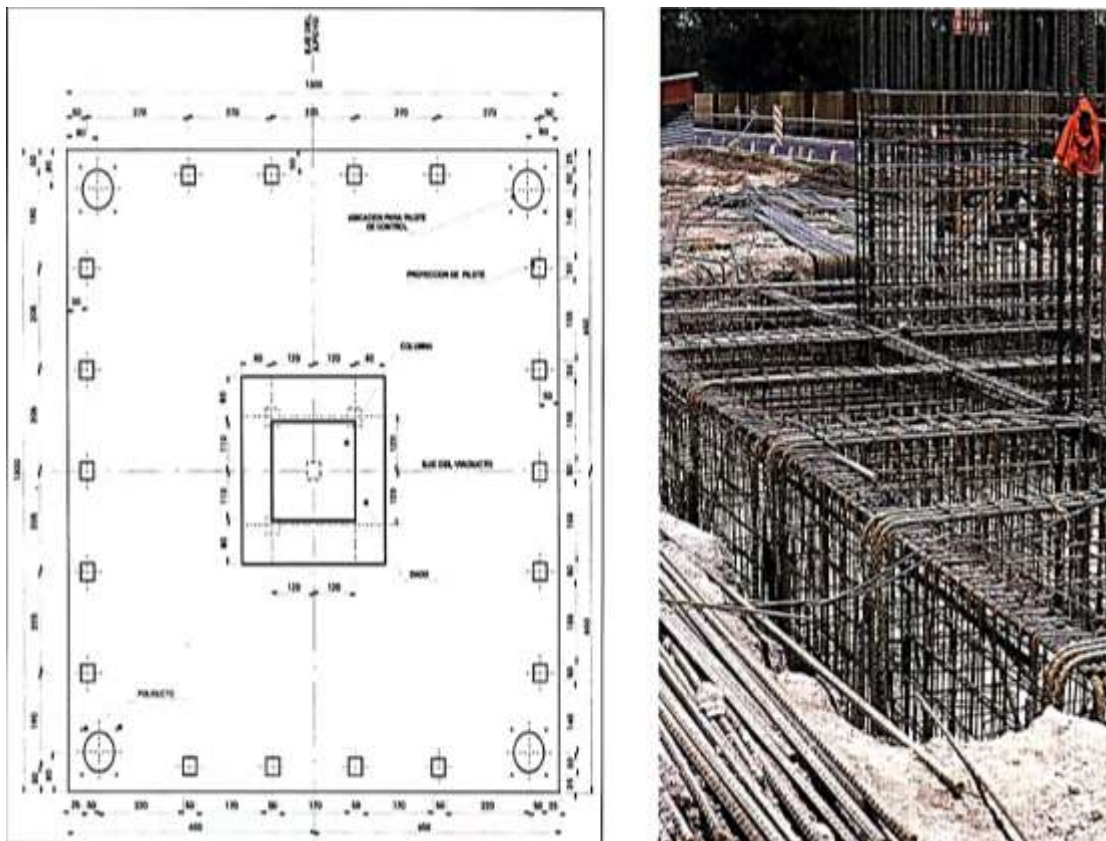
Zapata de una columna en tramo. Fuente: Grupo ICA, 1997.
